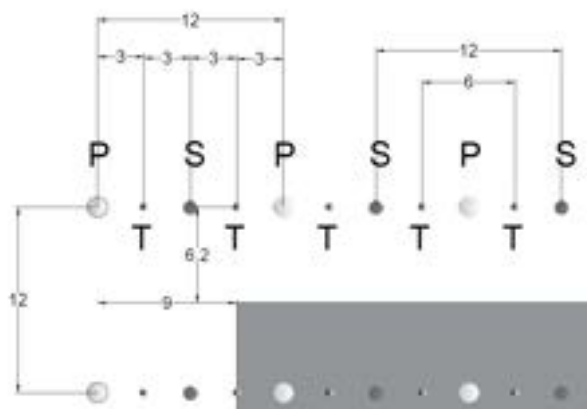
Detalles planta de inyecciones para mejoramiento de roca en fundación de cimacio visto en el cimacio
